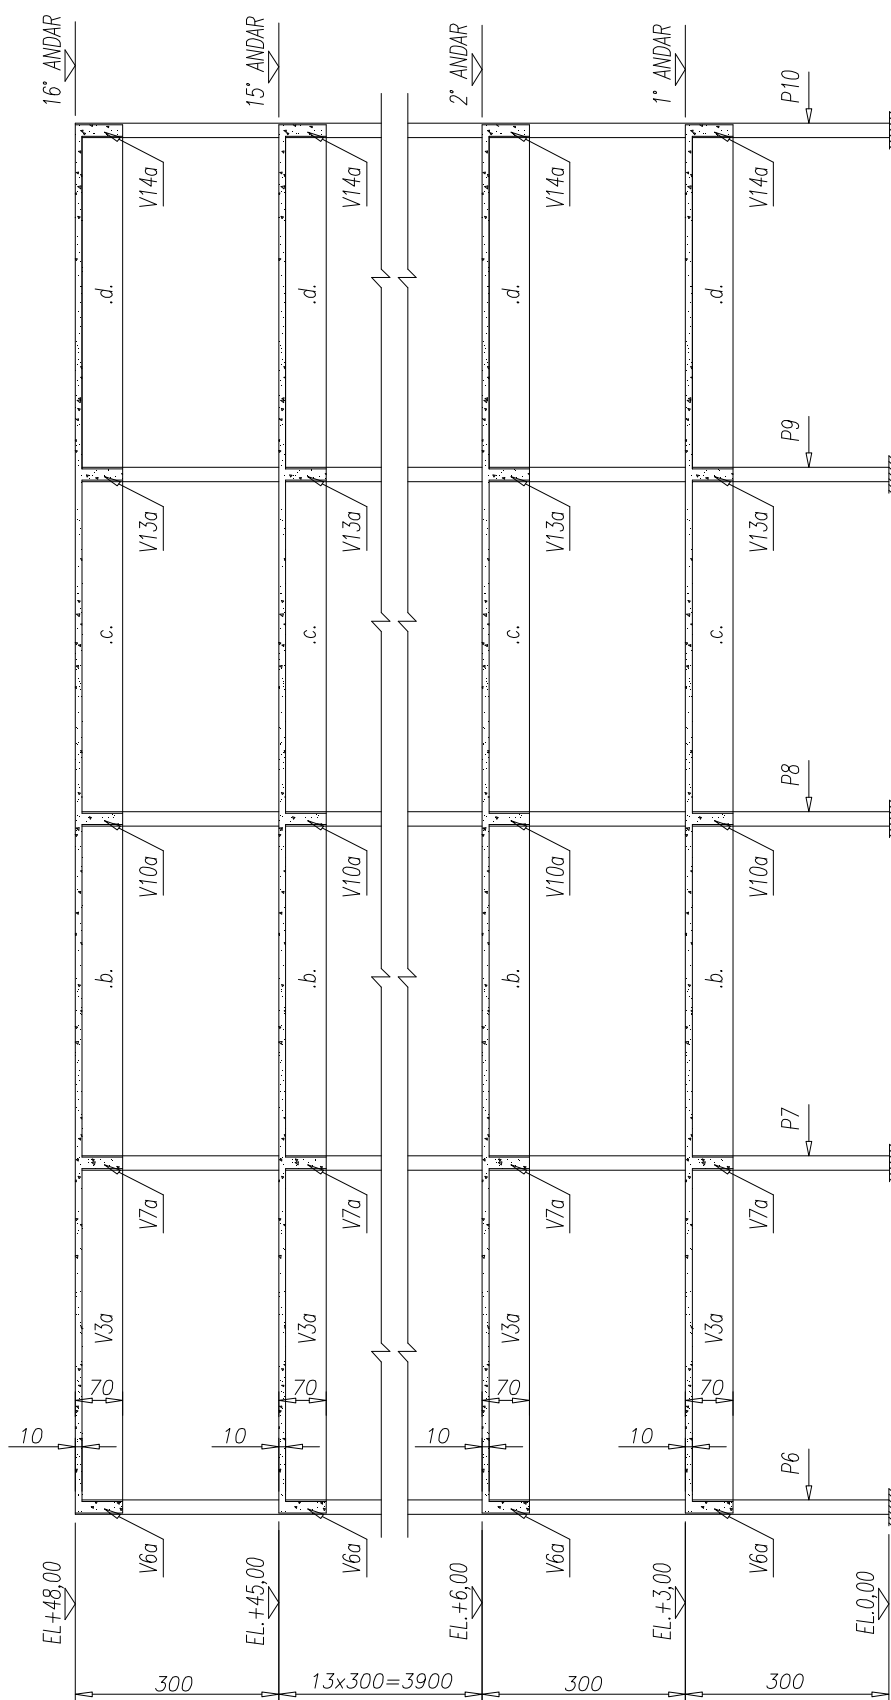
Corte A-A (Medidas e Cotas em Centímetro e Elevações em Metro)
